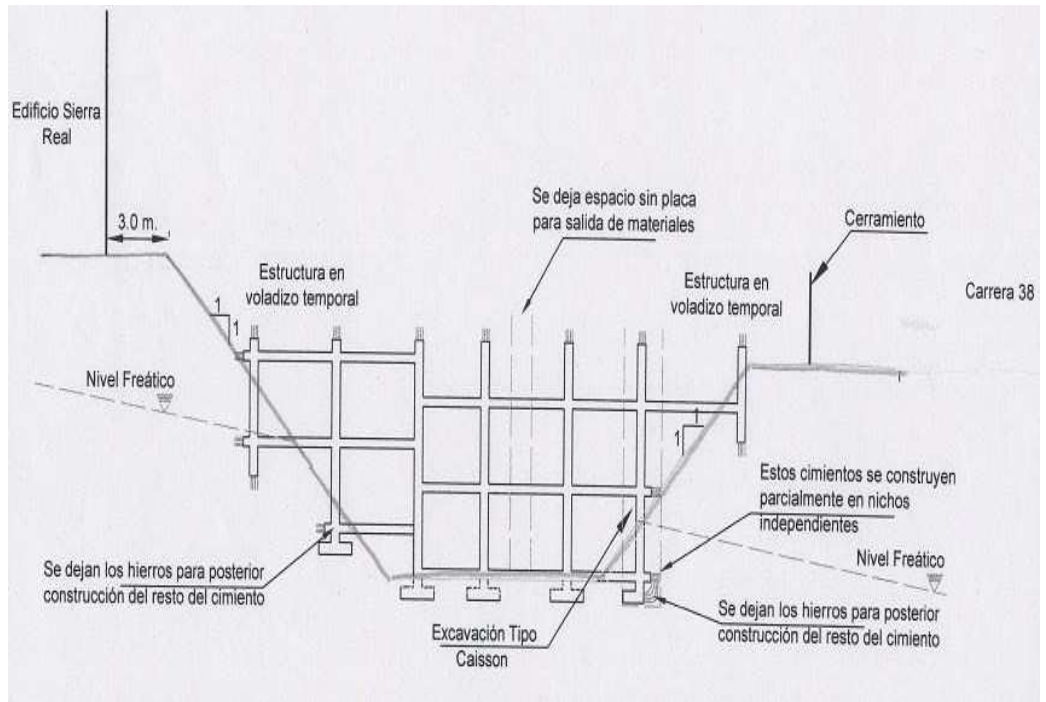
Diagrama 4 Construcción cimentación, Estudio geotécnico de suelo.
